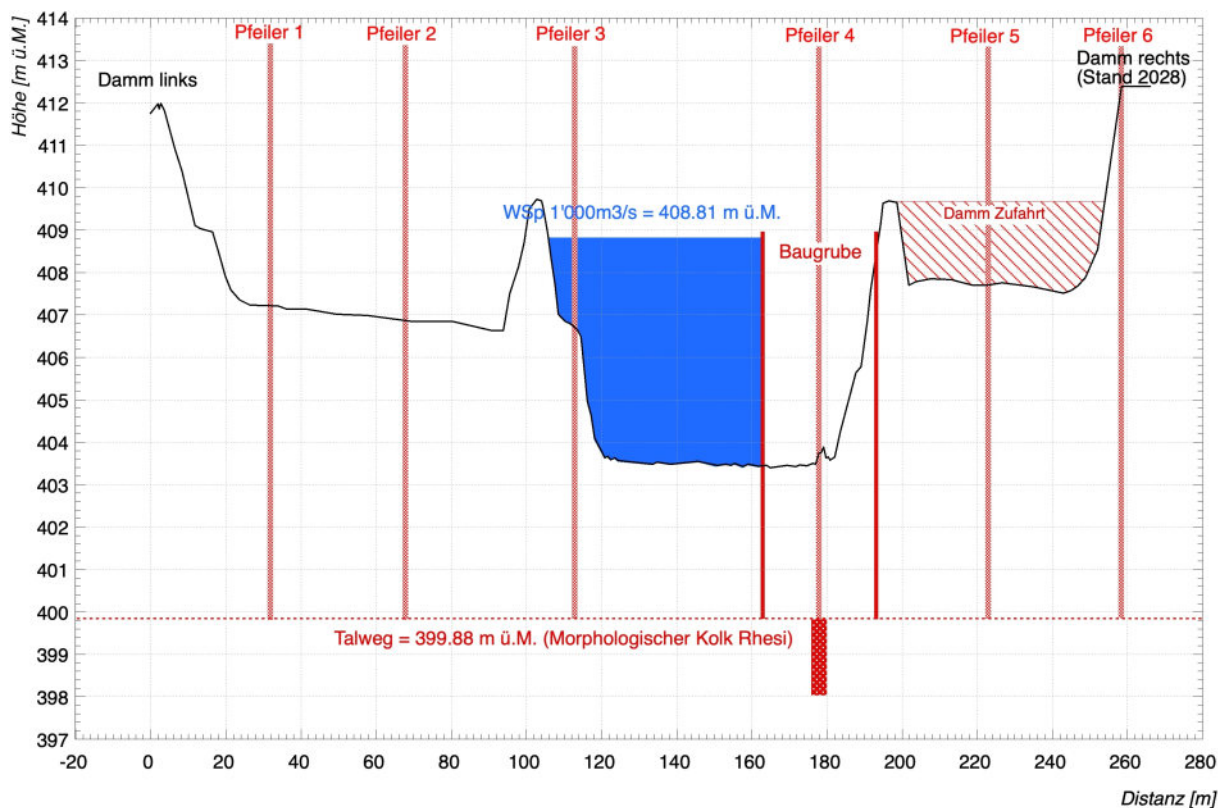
Rheinprofil km 79.380 im Bestand mit Baugrube und Baupiste (Damm Zufahrt) für die Erstellung eines im Hauptgerinne zu liegenden Pfeilers der FVV-Brücke inkl. Fundament. WSp: Wasserspiegel im Oberwasser der Baugrube.
